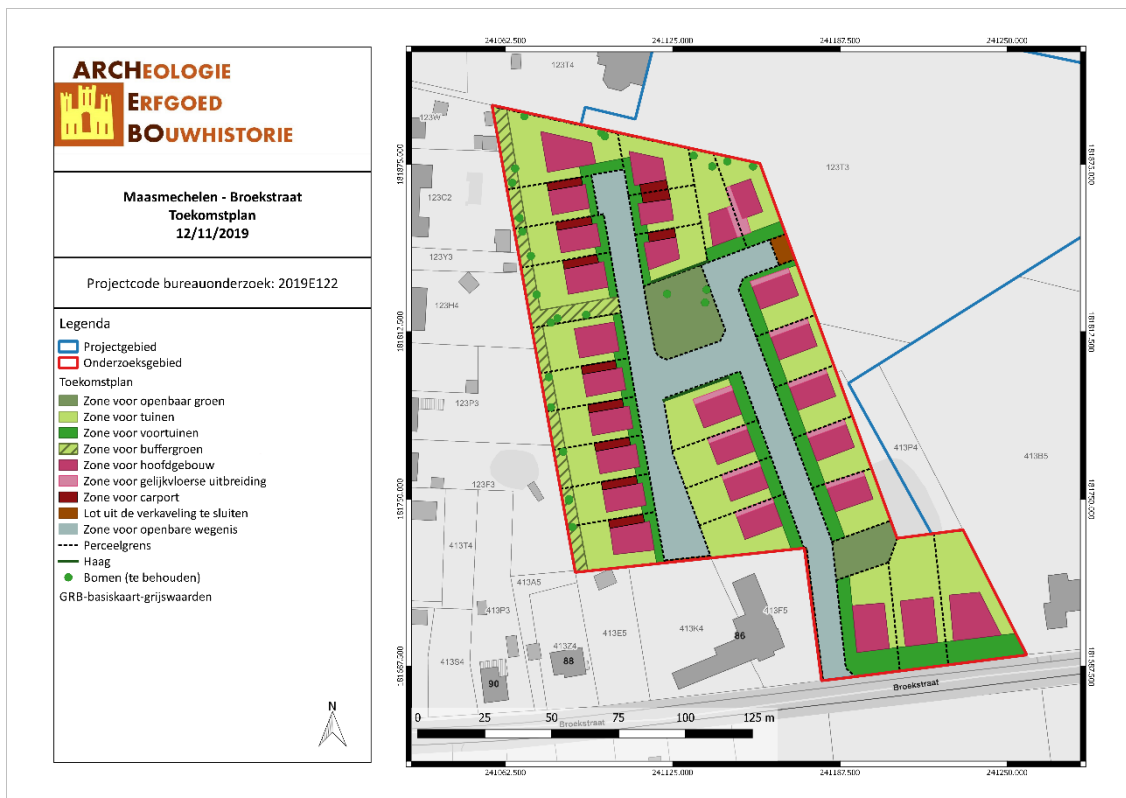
Plan van de geplande verkaveling (Opdrachtgever, 2019)
